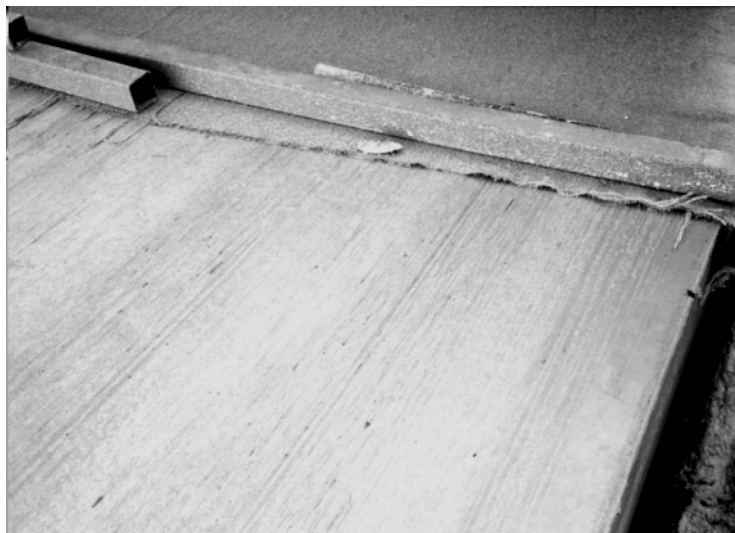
Beim Texturieren der Oberfläche des hochfesten Straßenbeton A44_B65 musste das nachgeschleppte Jutetuch beschwert werden [92]
